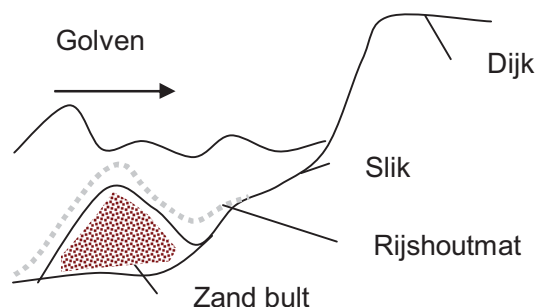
Constructies voor het verlagen van de dynamiek
